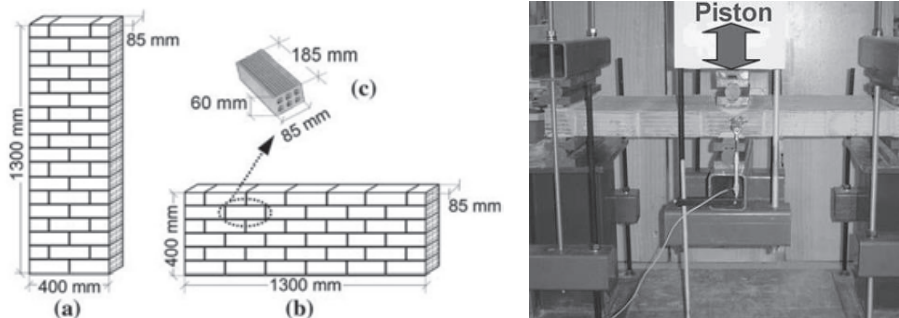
Wandausschnitte bei Belastung senkrecht zur Lagerfuge a) und parallel zur Lagerfuge b) (links), Versuchsaufbau des Drei-Punkt-Biegeversuchs (rechts) aus [164]
